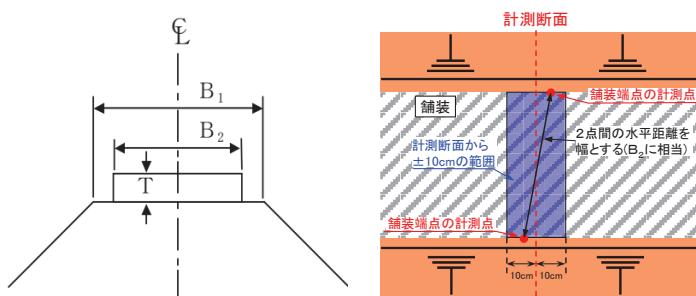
出来形測定箇所標準図（左：横断図、右：平面図）
